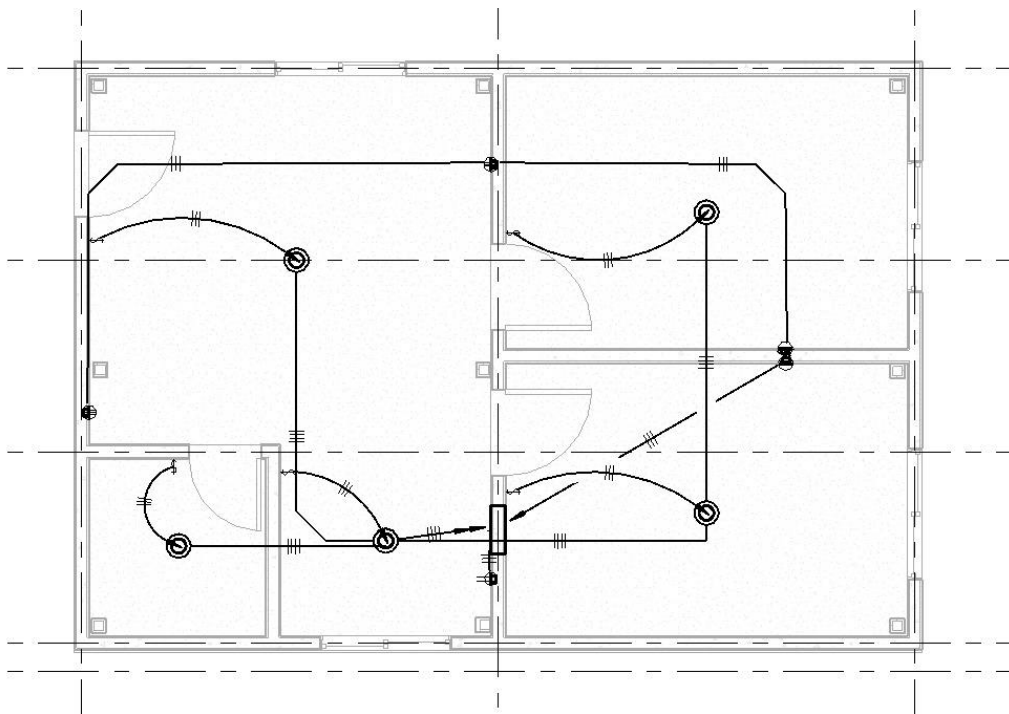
Vista en planta de distribución para instalaciones eléctricas de vivienda autosustentable, Elaboración propia (2021)
